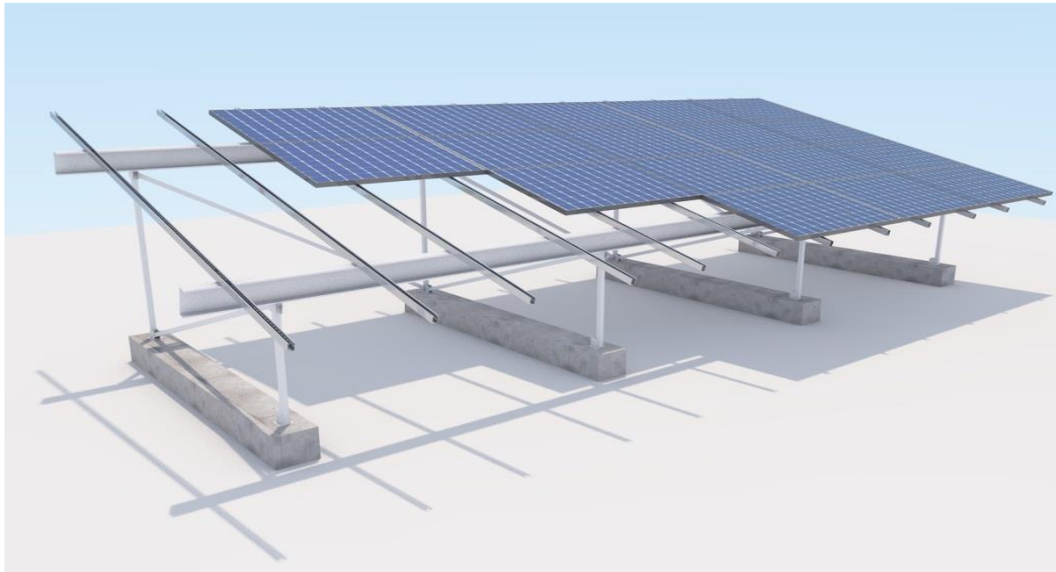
Installation en pose au sol (sur longrine béton). [1]
